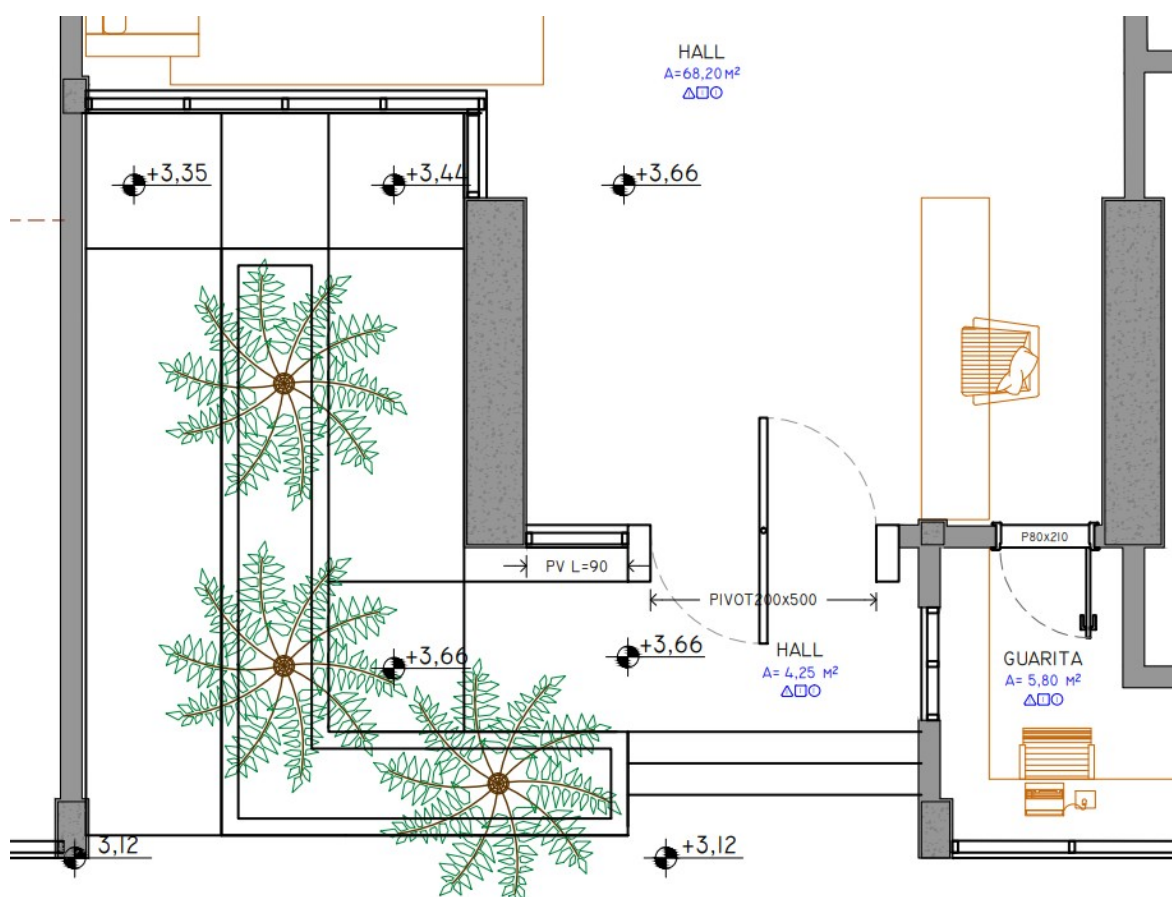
Detalhe para o hall de acesso ao Edifício junto a fachada com a Rua 1041.
